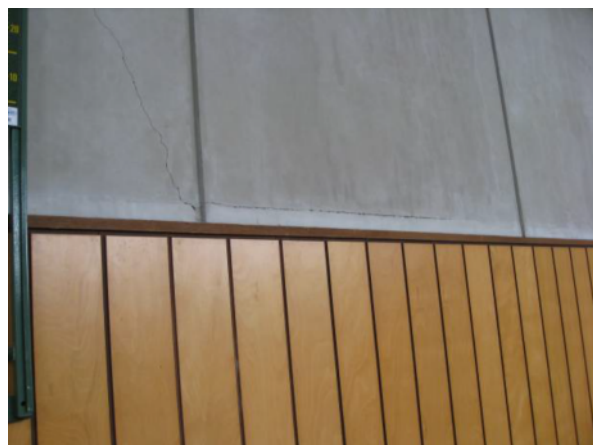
アリーナ RC 壁の軽微なひび割れ
